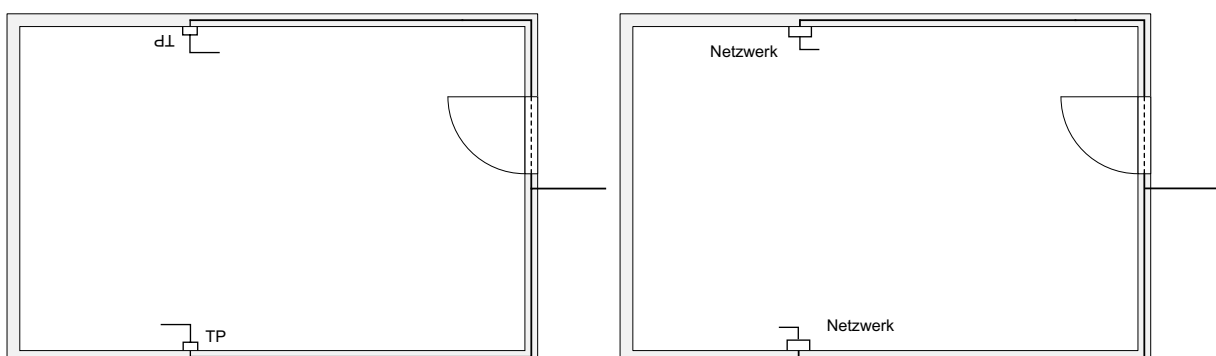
Horizontaler Schnitt - Grundschemata der Leitungsführung der Telefon- und Netzwerkleitung eines Standardraumes⁵¹⁵
